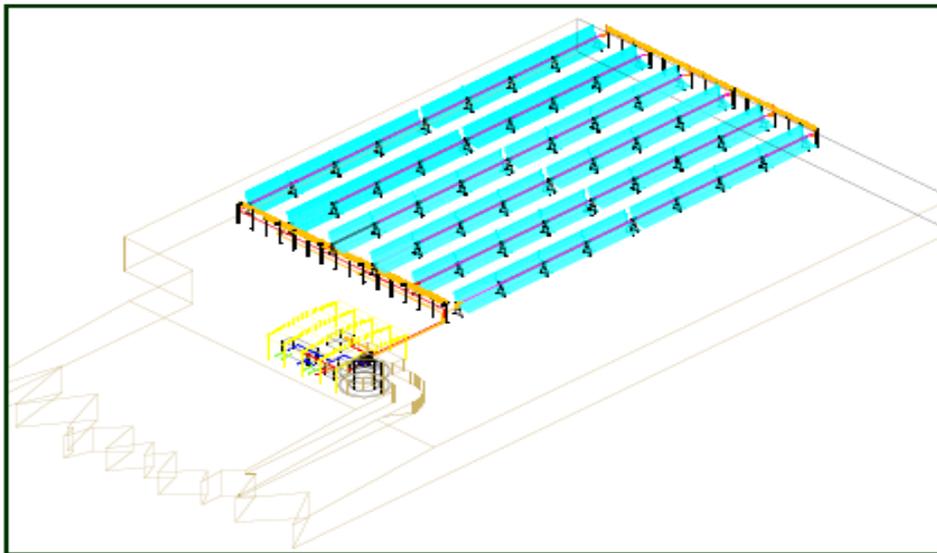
Rappresentazione 3D dell'impianto MODULO CSP
